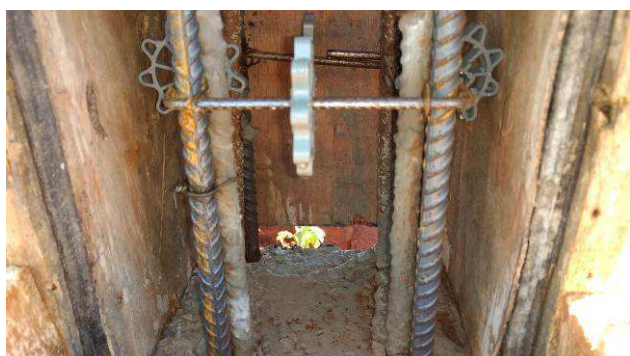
C: Formas e armaduras do pilar P61 do prédio principal.
